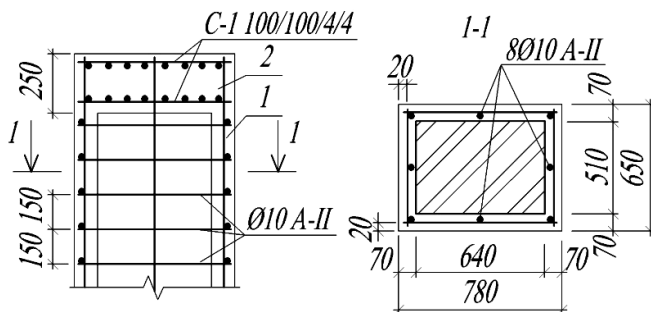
Схема усиления кирпичного столба железобетонной обоймой:
